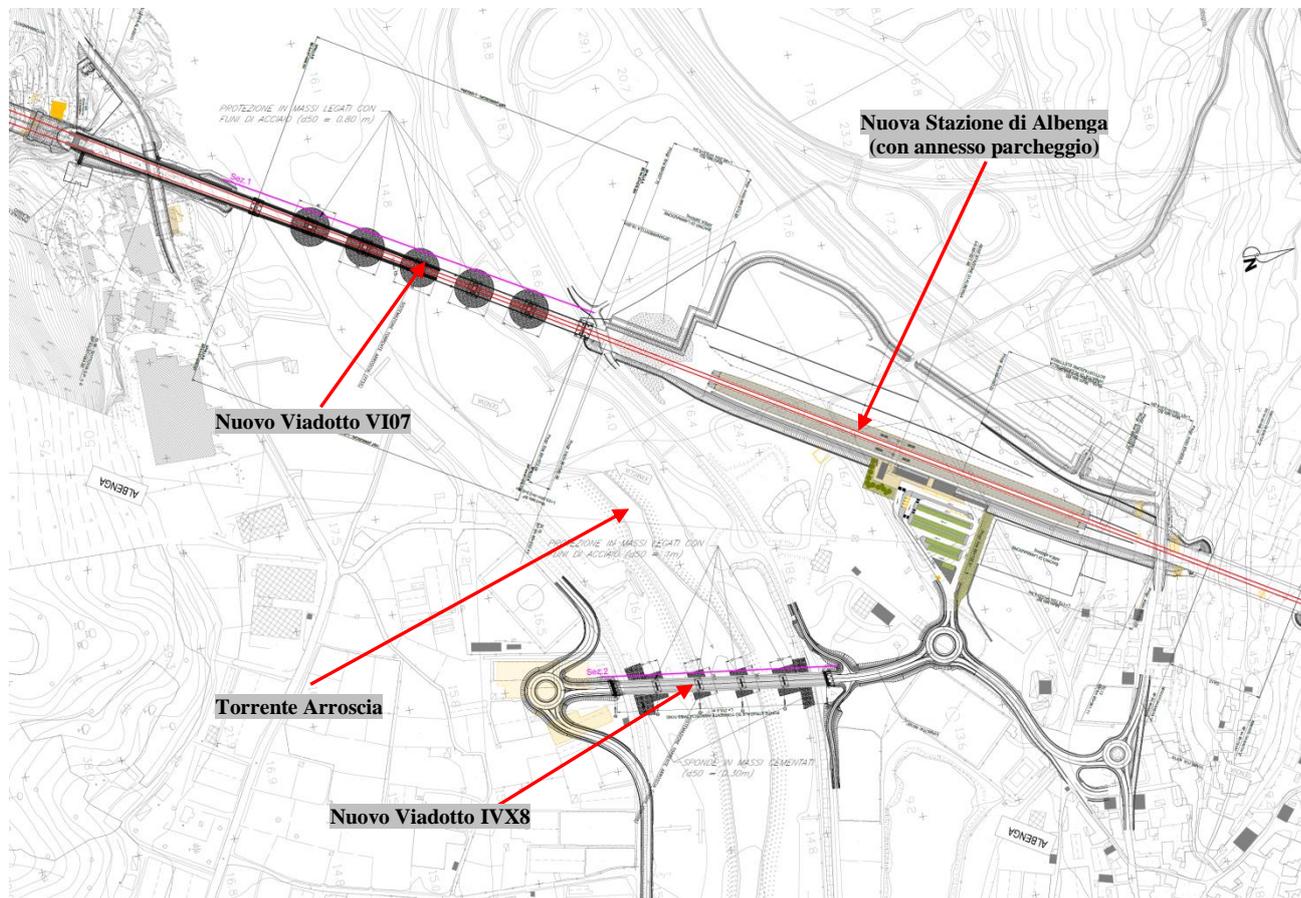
Stralcio della planimetria di progetto in quel di Albenga (attraversamento del Torrente Arroscia).
